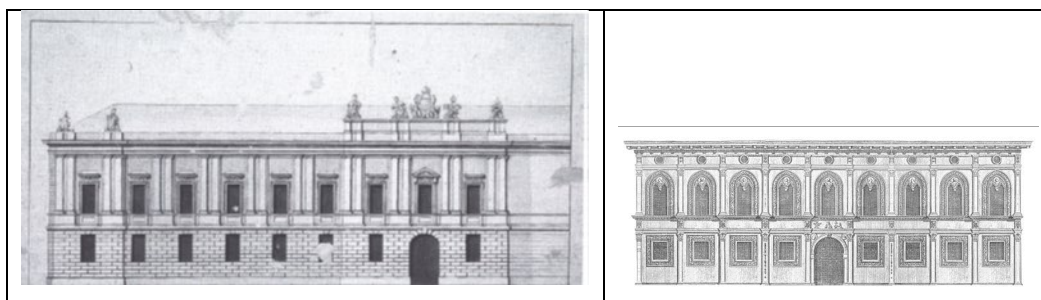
Piermarini, Prospetto del Monte di S. Teresa (1782) e la facciata del demolito Palazzo Marliani
